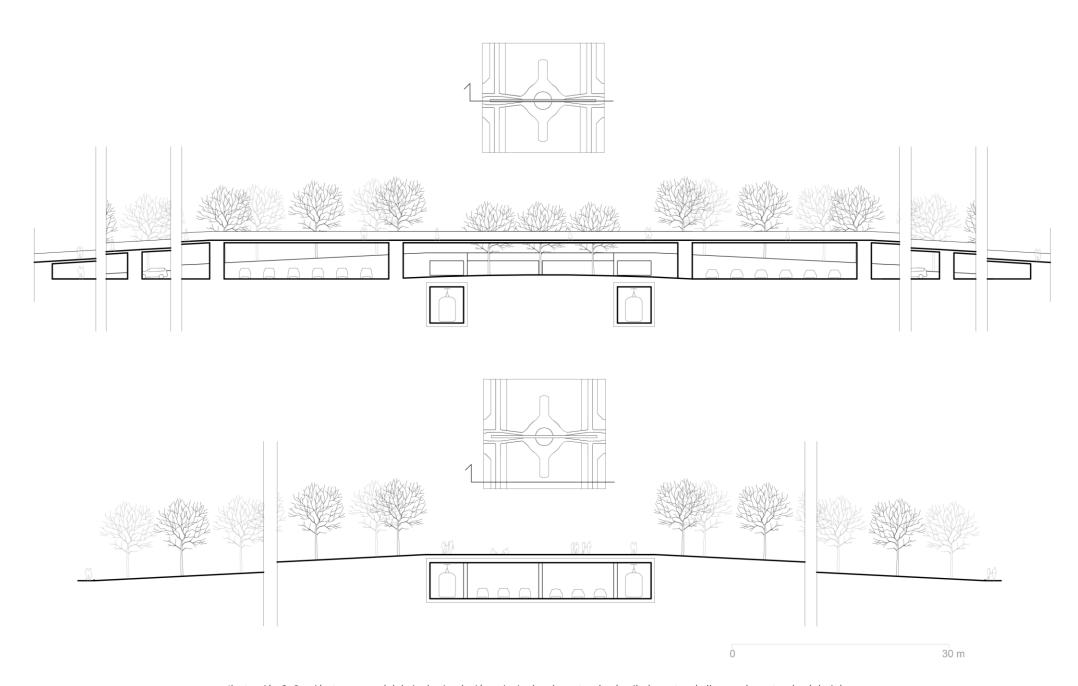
Sección transversal del eje de circulación principal en las rotondas (arriba) y antes de llegar a las rotondas (abajo)
